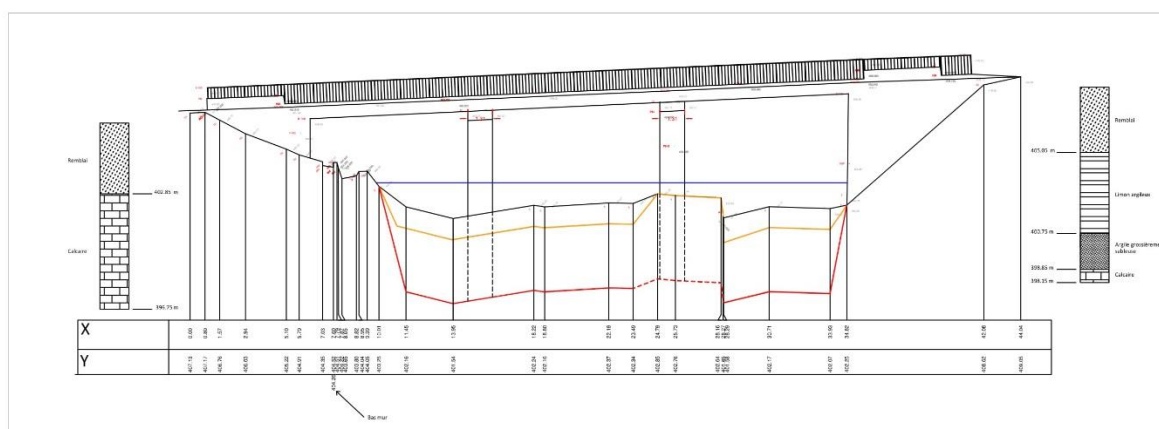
Comparaison du fond actuel et affouillement minimal (orange) et maximal (rouge)
